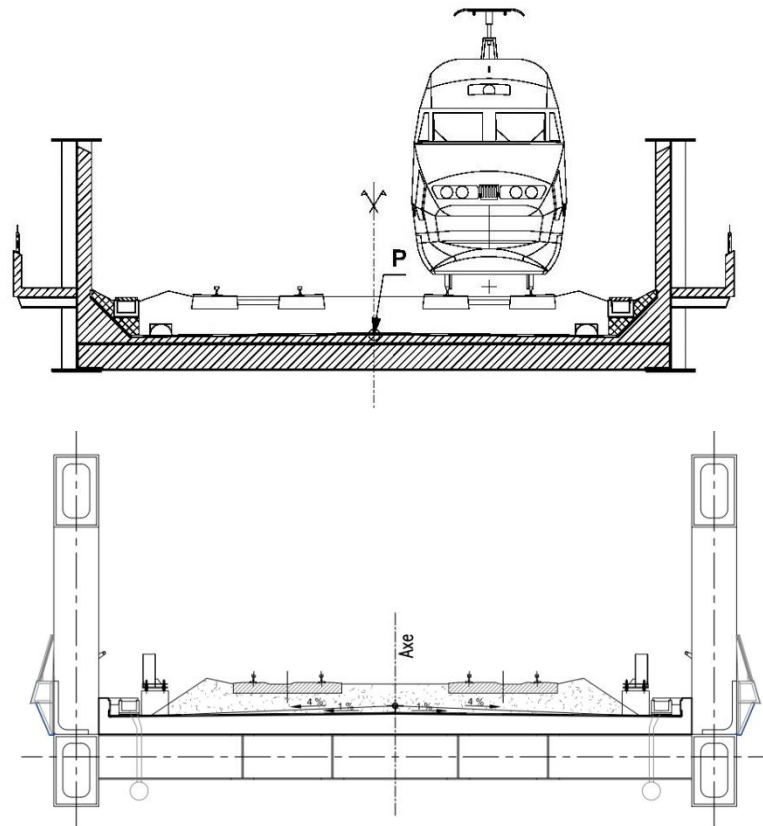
Coupe transversale – Ouvrage à poutres latérales et ouvrage Warren (source : INGEROP)
